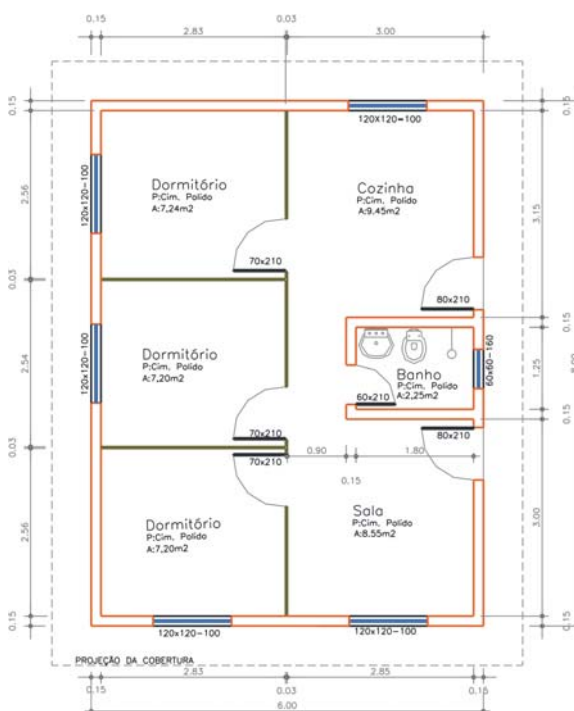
Vedações em Alvenaria - Planta Baixa – Área: 48,00 m²
